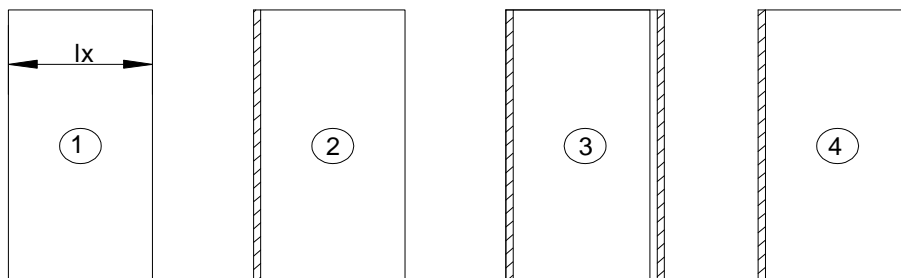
Condições de Apoio para Lajes Armadas em Uma Direção
